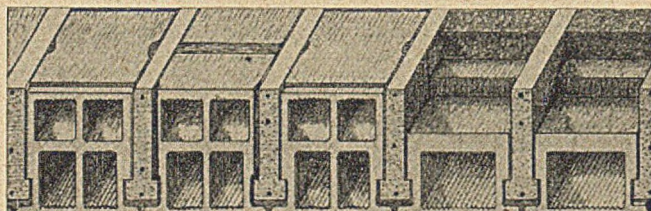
Stahlstrebenbetondecke nach Müllpo.
